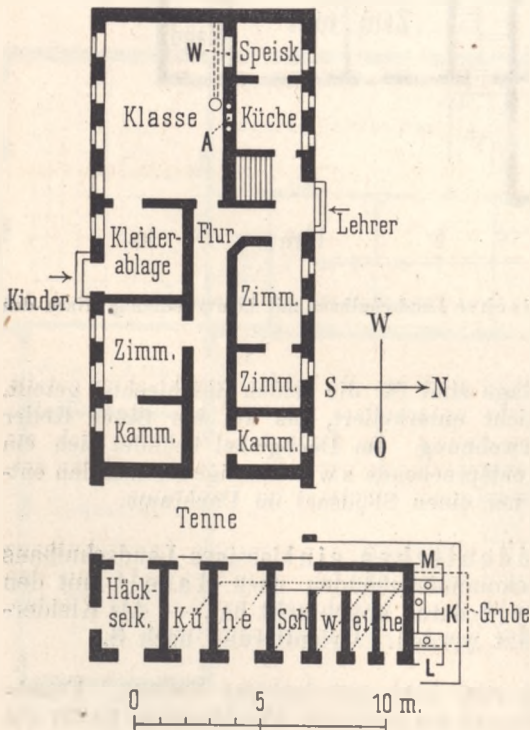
Einklassiges deutsches Landschulhaus mit Lehrerwohnung und Oekonomiegebäuden im Kreise Isenhagen, nach Langerhans, mit Abänderungen.
